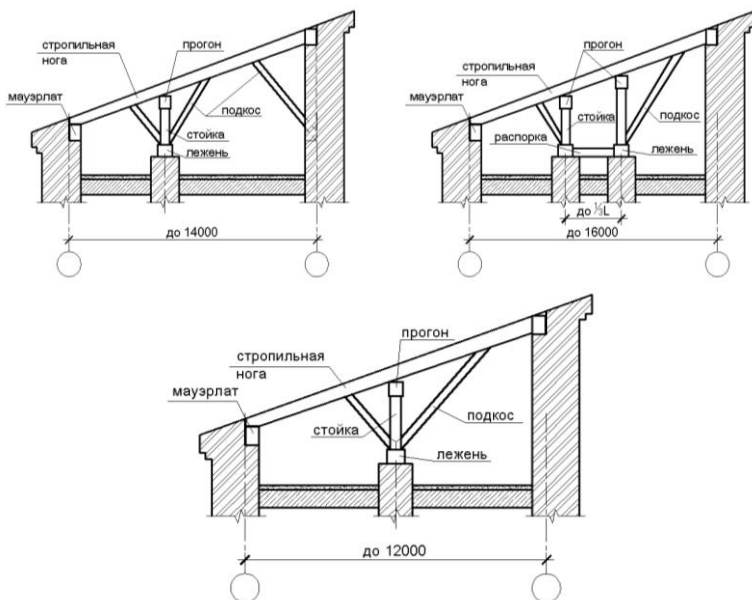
Конструктивные схемы односкатных крыш с наслонной стропильной системой
